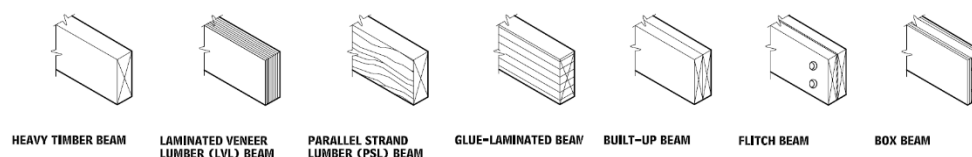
Produtos de madeira utilizados nas vigas: viga maciça, viga de LVL, viga de PSL, viga Glulam, viga composta pregada, viga composta aparafusada e viga composta tipo "caixa" (American Institute of Architects, 2008).
